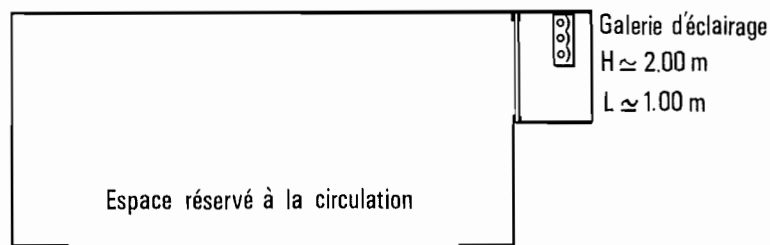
Tunnel Rugen sur la N8 (Suisse).
